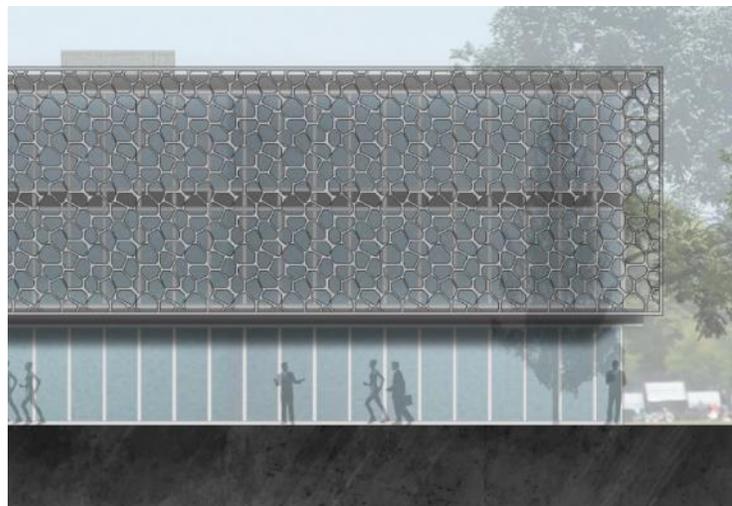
Detalle muro cortina y doble fachada. Elaboración propia
